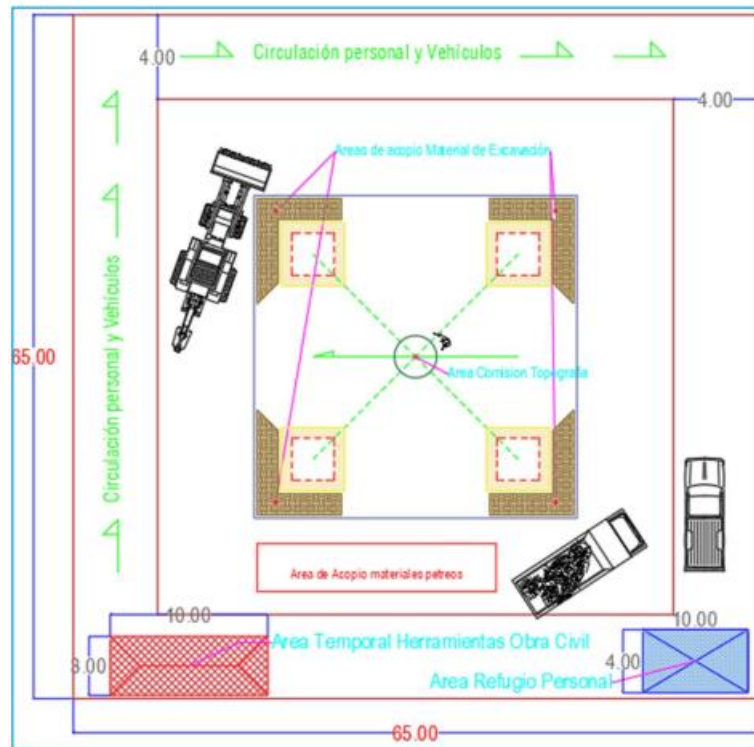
Área de trabajo Obra Civil 65 x 65 m
